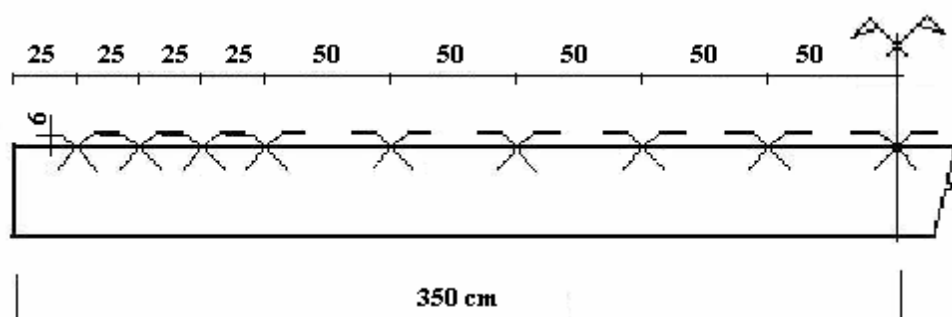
Disposição dos conectores “X” nas vigas de madeira. Fonte: Pigozzo (2004).
